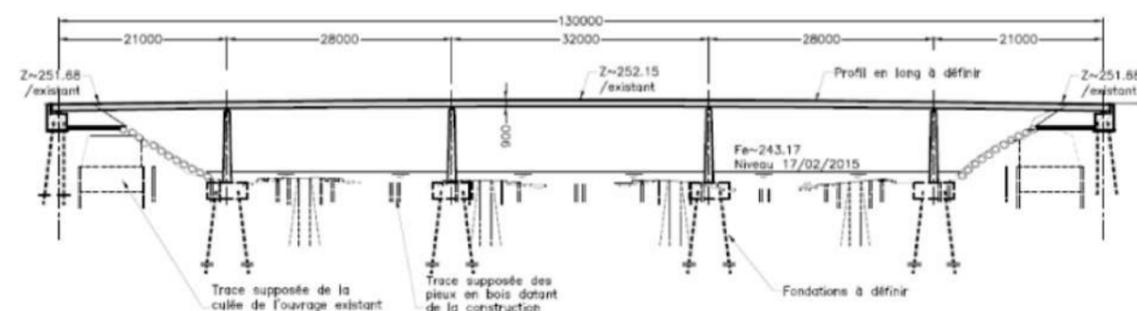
Coupe de l'ouvrage à poutrelles enrobées à cinq travées
